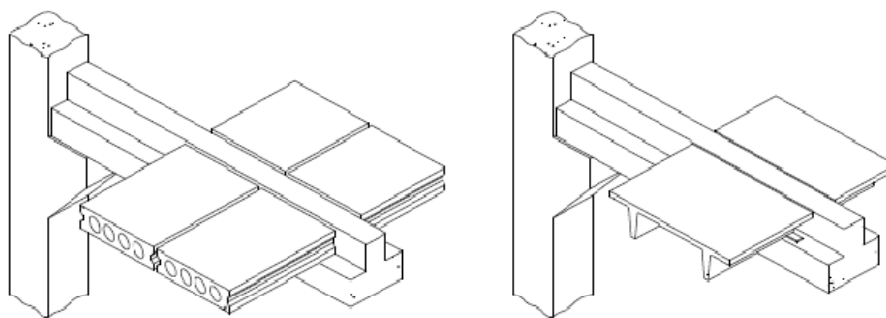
Exemplos de sistemas estruturais em concreto pré-fabricado, sendo à esquerda uma laje alveolar e, à direita, uma laje “pi”
